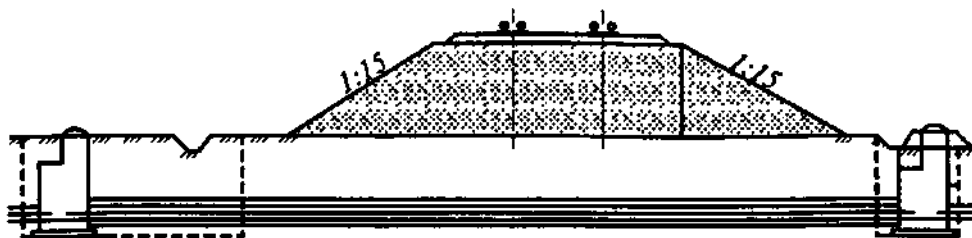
Переход водопроводом в фугляре под железнодорожными путями
